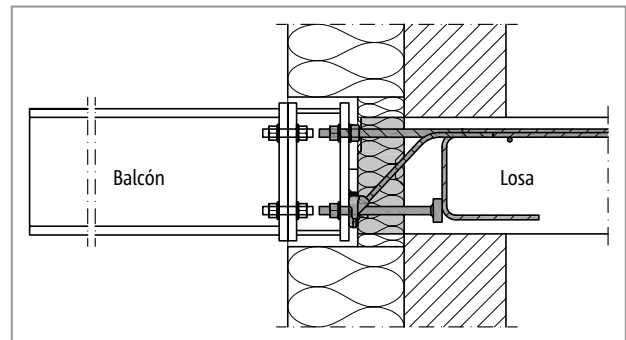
Schöck Isokorb® T tipo SK: Conexión del soporte de acero a un adaptador que compensa el espesor del aislamiento exterior
